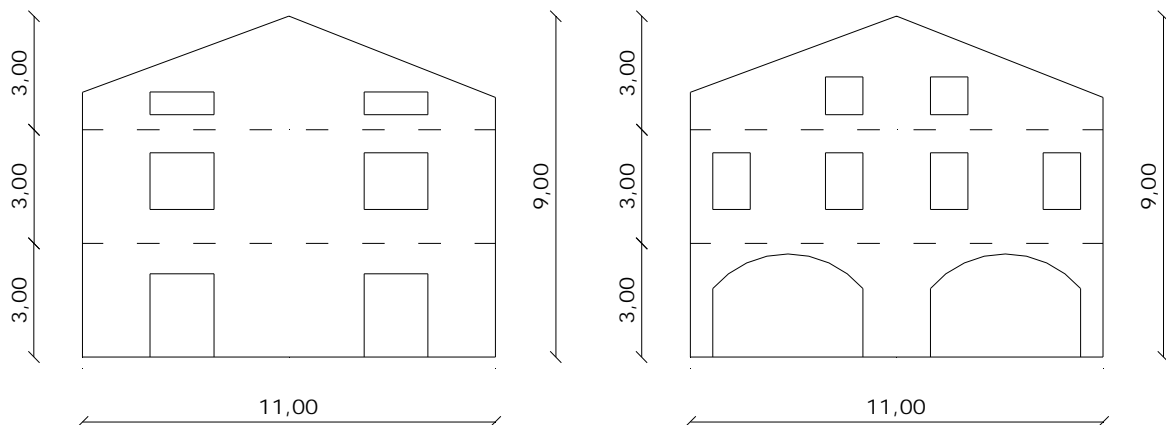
Geometria dell'edificio oggetto di studio.
